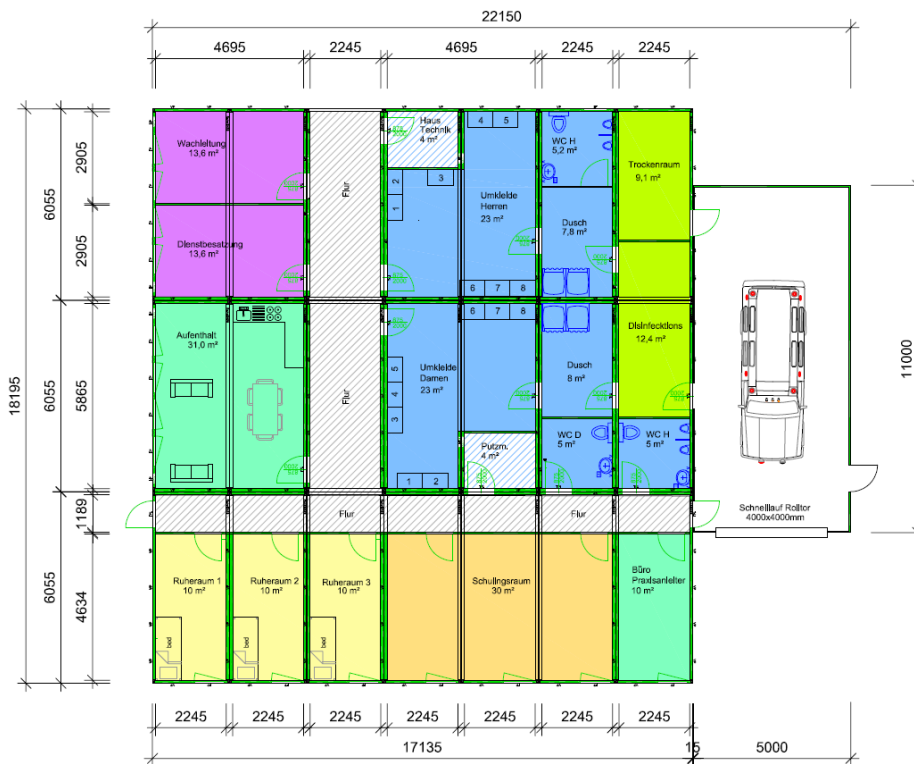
Ausschnitt aus dem Grundriss Malteser Kirberg Containeranlage Oswald Matt Group, unmaßstäblich
